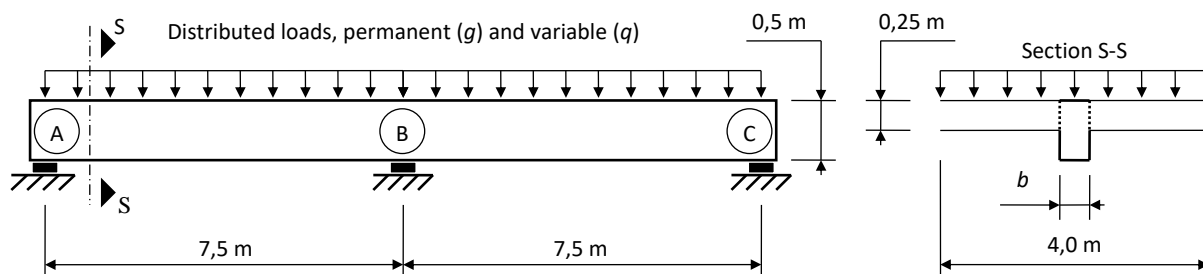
Viga de hormigón armado, continua de dos vanos iguales
